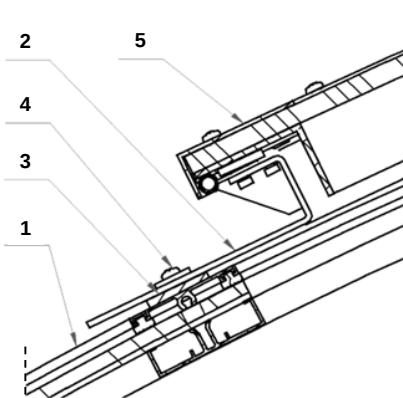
Zamontowana klapa 2-skrzydłowa w paśmie łukowym
